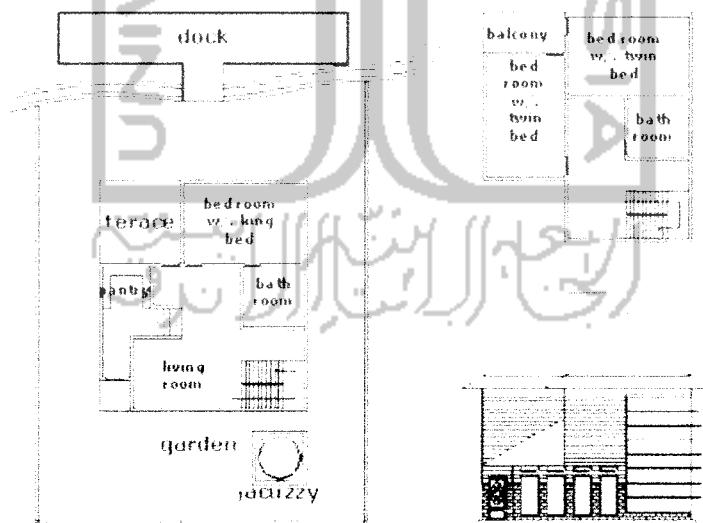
Denah dan Tampak Type Executive Suite
